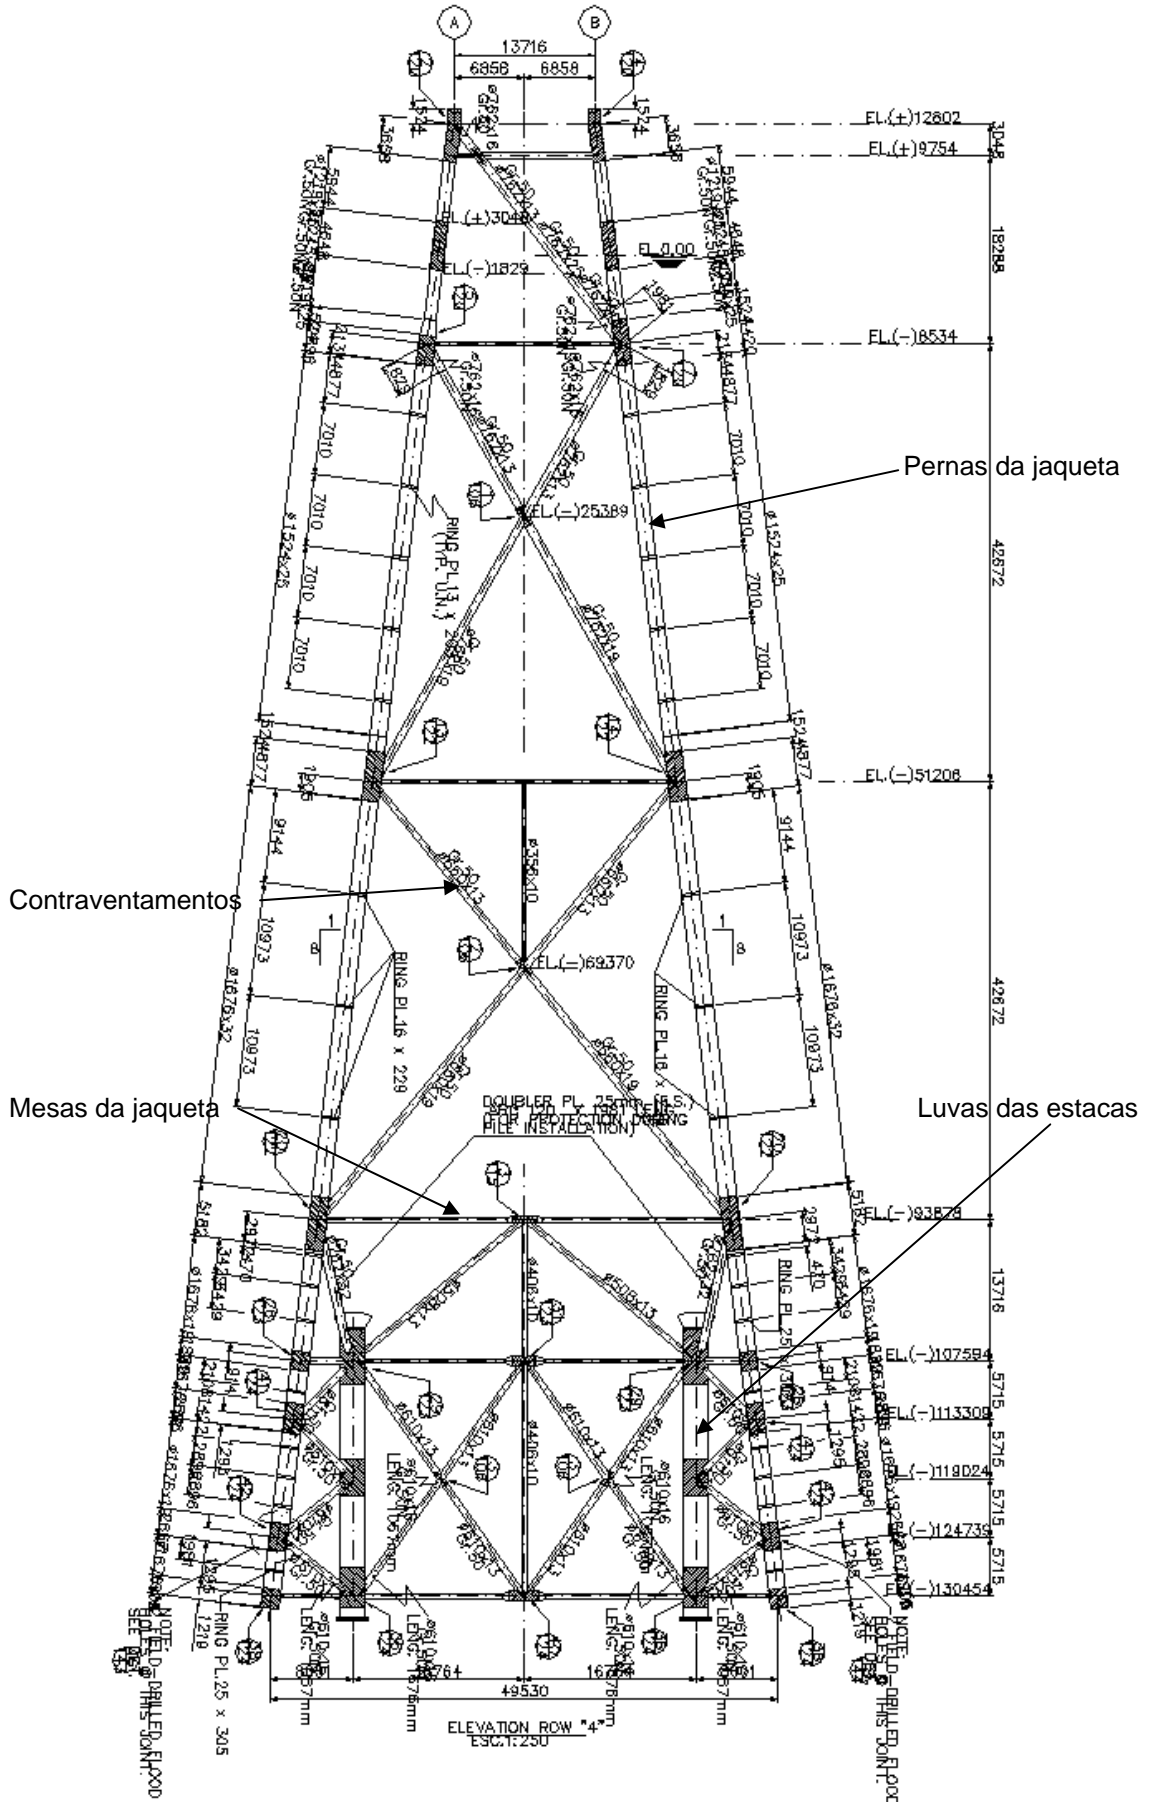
Jaqueta – Elevação do Eixo 4 (cotas em mm)
